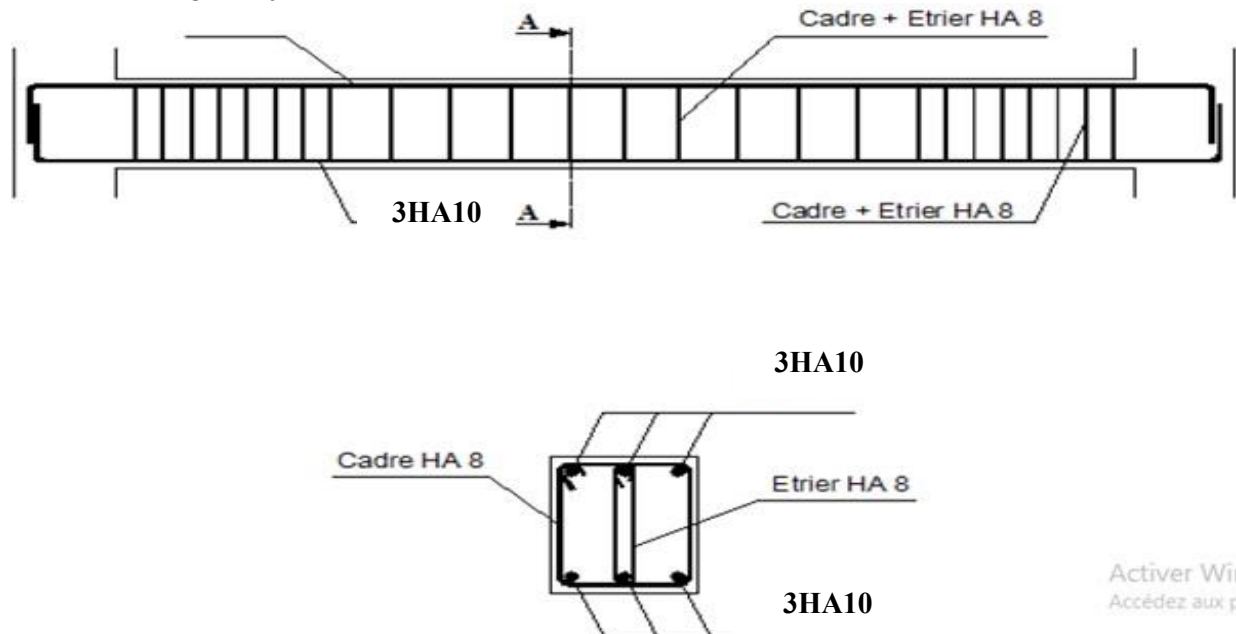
Ferrailage de la poutre de chaînage reposant sur deux appuis
